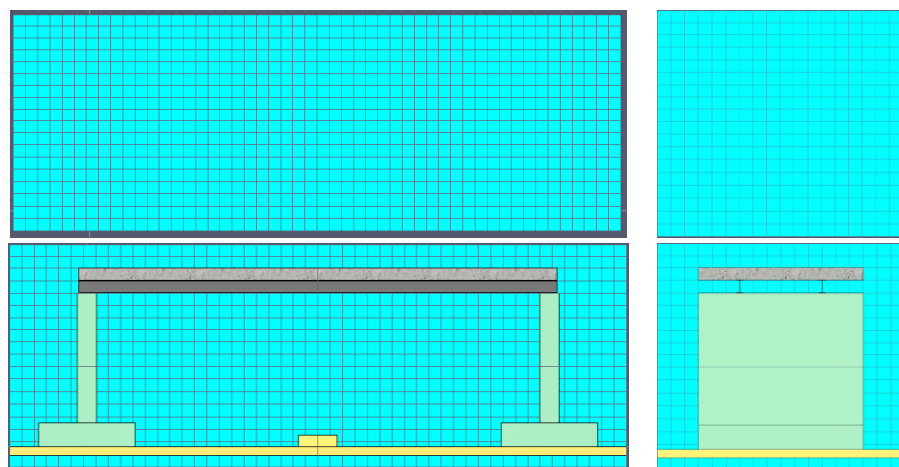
Vistas en alzado y perfil del modelo de mallado L.
